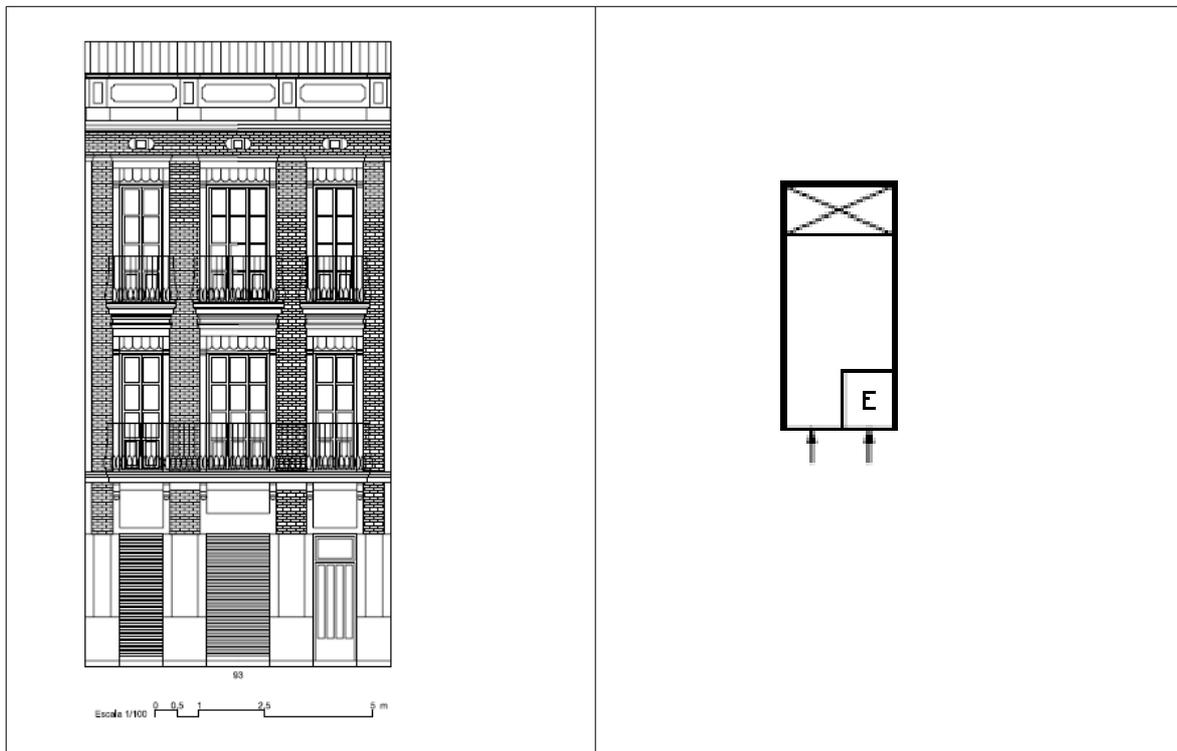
Tipo B3. Ejemplo de fachada y esquema de planta (ficha 310-07)
